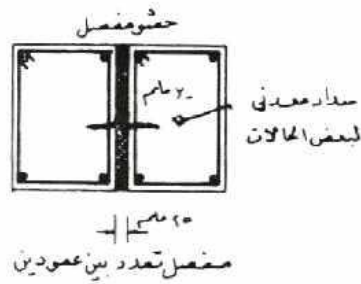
٤) مفصل تمدد مع وسادة
